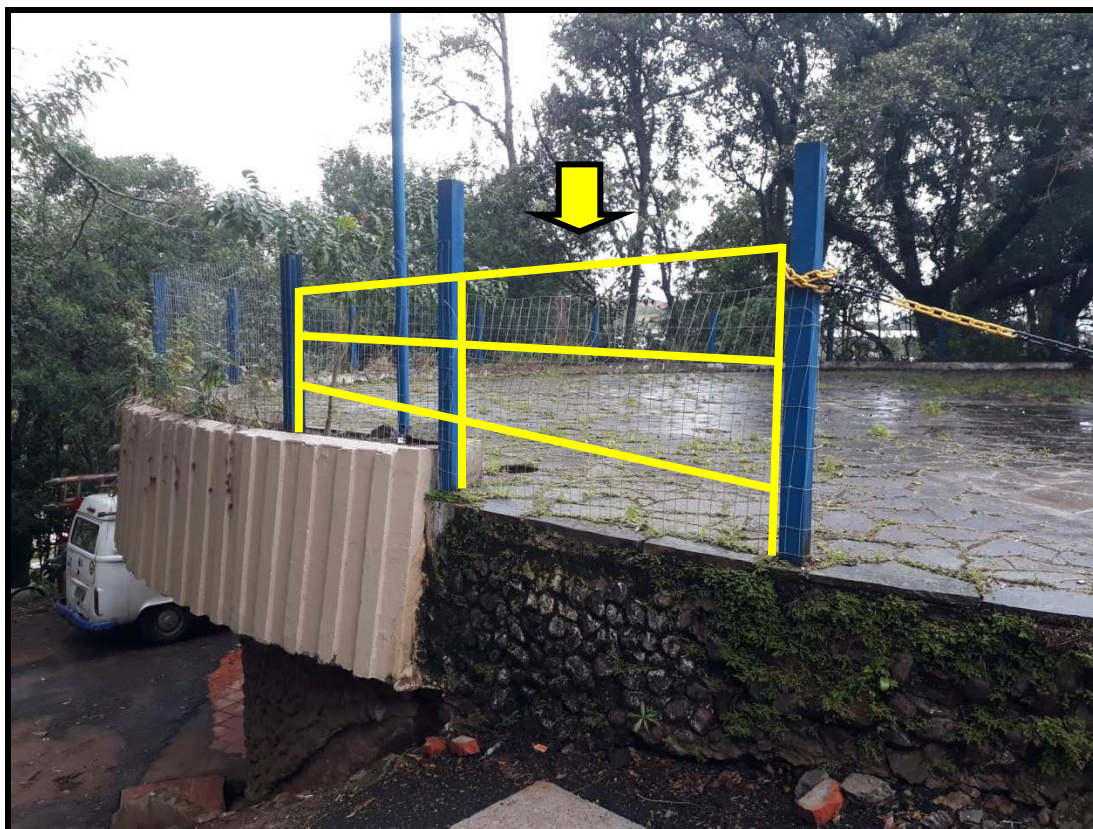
| Telas metálicas a serem substituídas, no perímetro sobre a laje do Restaurante
